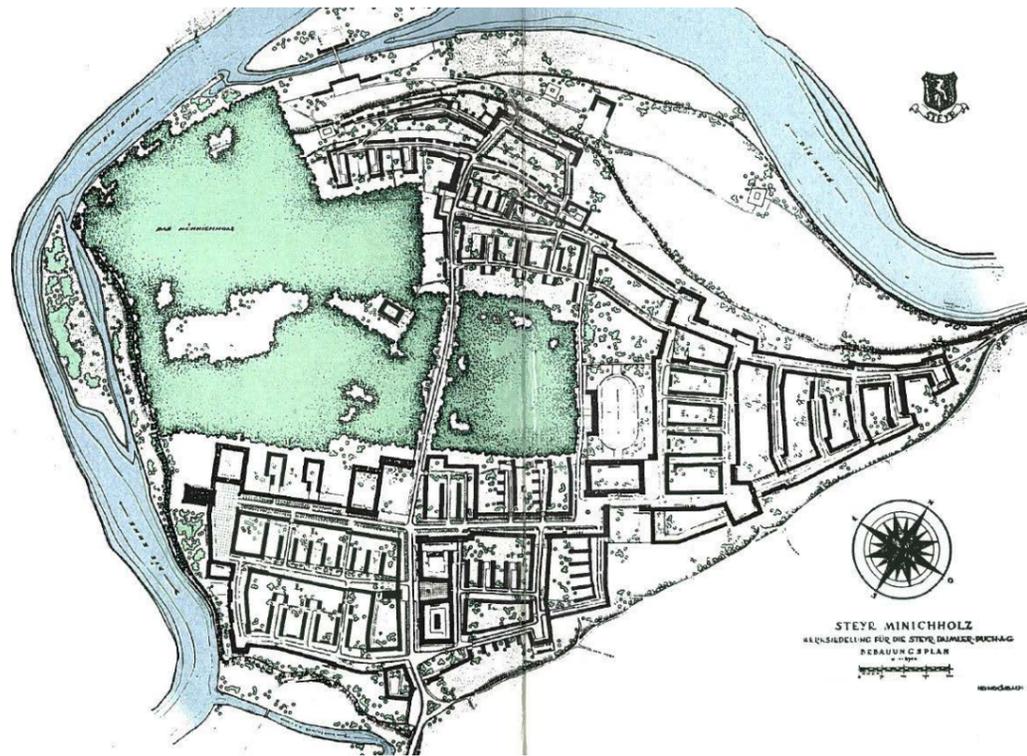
Ursprünglicher Masterplan, Quelle: Dr. Retzl, H. (1986): „Münchenholz – ein Stadtteil im Wandel der Zeit“, S. 32f.
